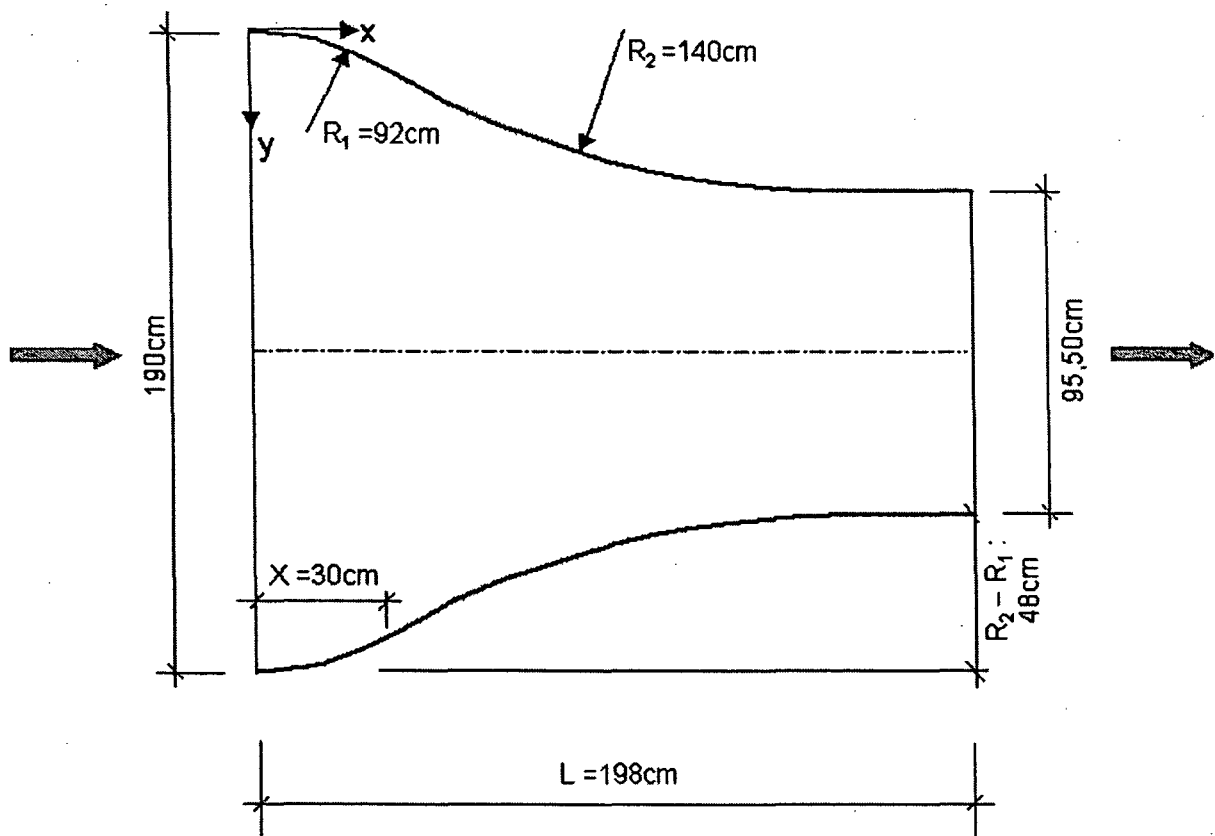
Einlauftrumpetenform im Grundriss.
